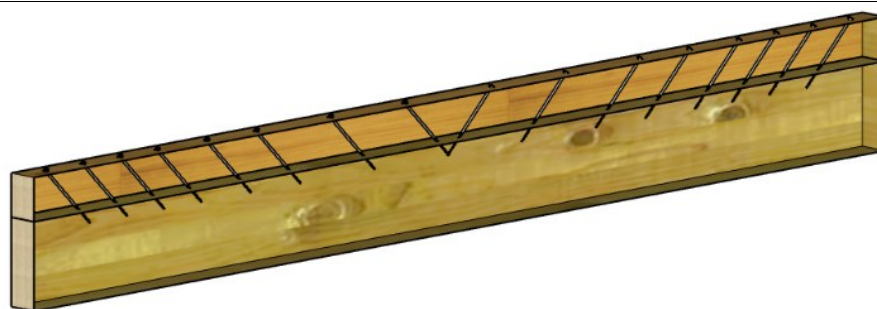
Renfort bois en face supérieure assemblé par vis inclinées
